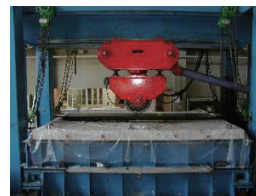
輪荷重走行試験 写真-2 床版への剥離剤塗布
